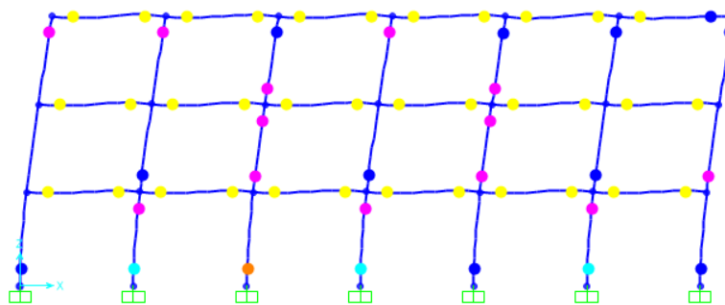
Rótulas plásticas y mecanismo de colapso para módulo de 3 pisos sin interacción tabique - pórtico.
